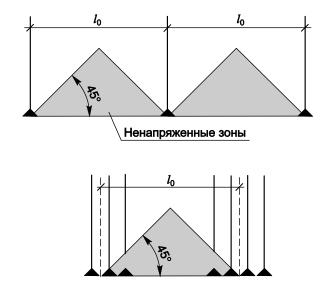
Схемы расположения ненапряженных зон, в которых следует устанавливать дополнительную ненапрягаемую арматуру
